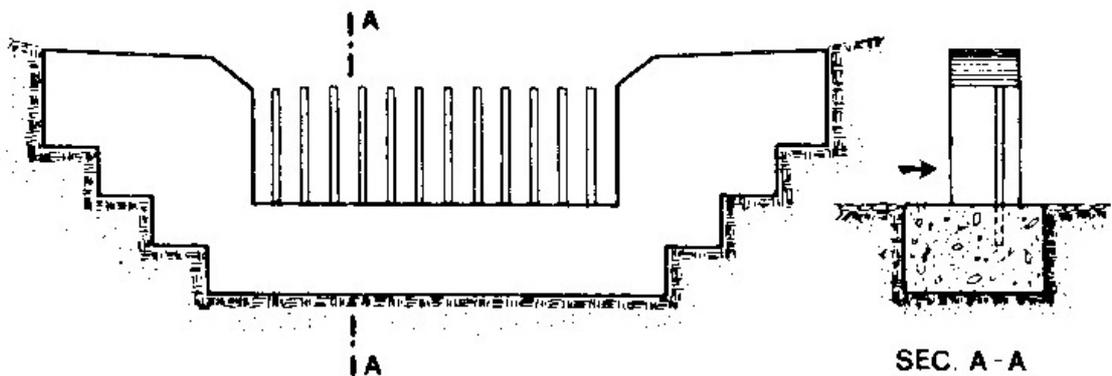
Dique tipo rastrillo con piezas verticales (a peine) (fuente: AIDI-IILA, 1983).
